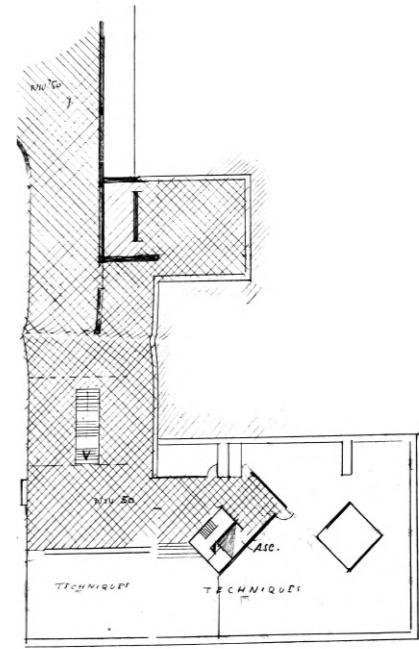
Plan du dernier niveau inférieur de l'Altenloh, affecté aux locaux techniques, ébauche du musée camouflé.
